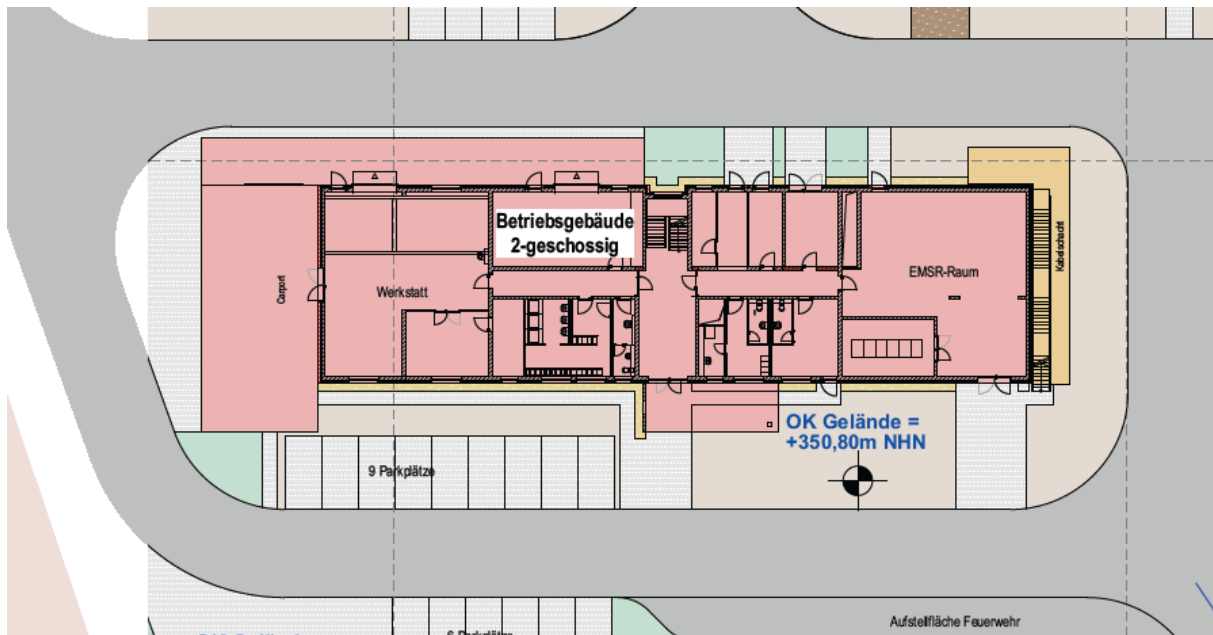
Ausschnitt aus dem Freiflächenplan - Betriebsgebäude
